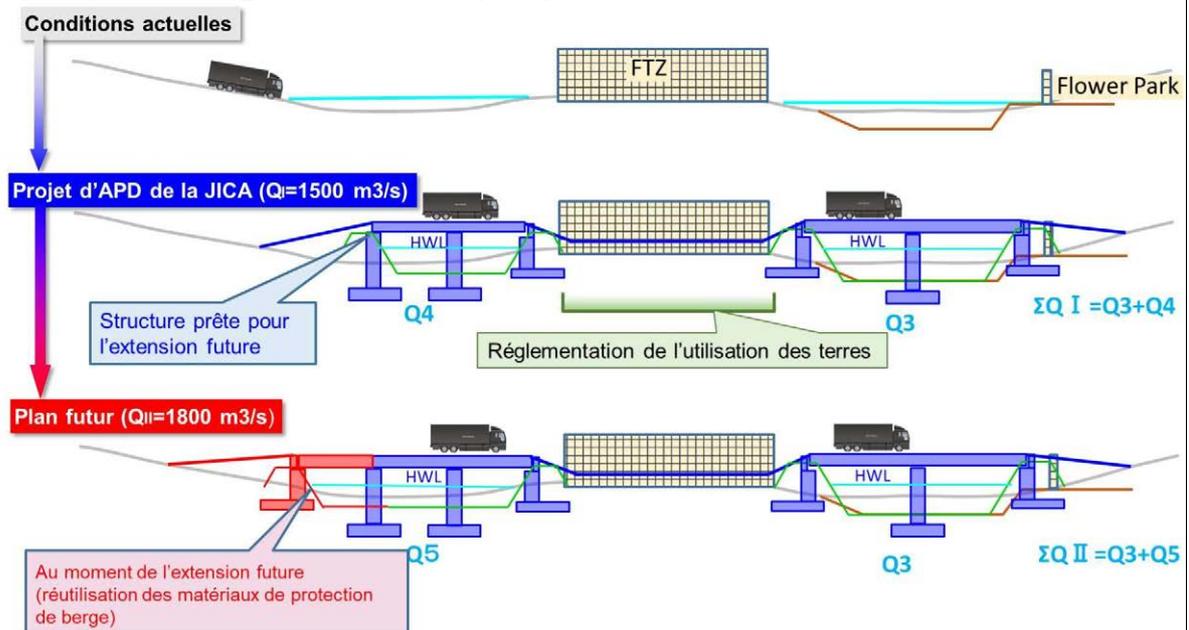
Route de Palmeraie - plan d'aménagement par étapes (proposition)
